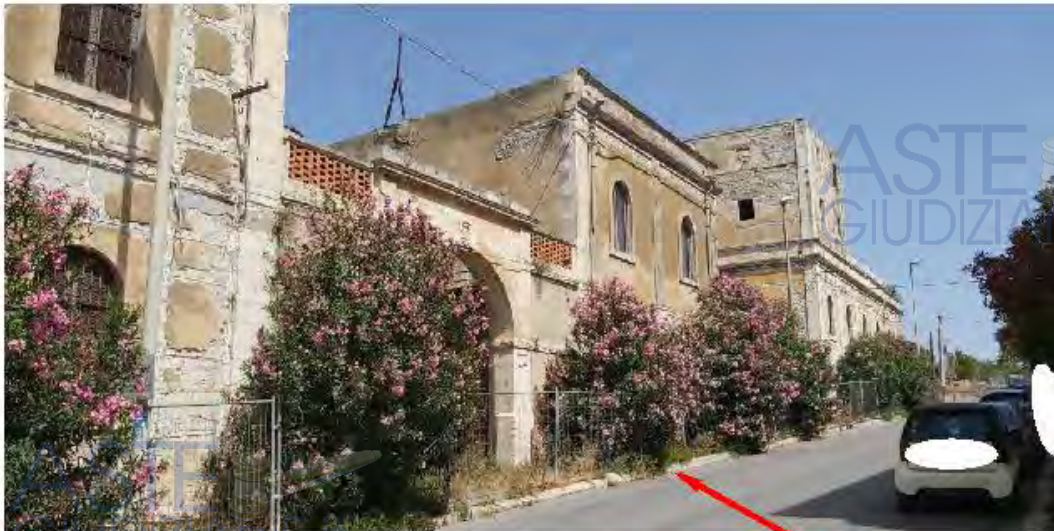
Foto Prospettica su Via Giuseppe Mazzini.
